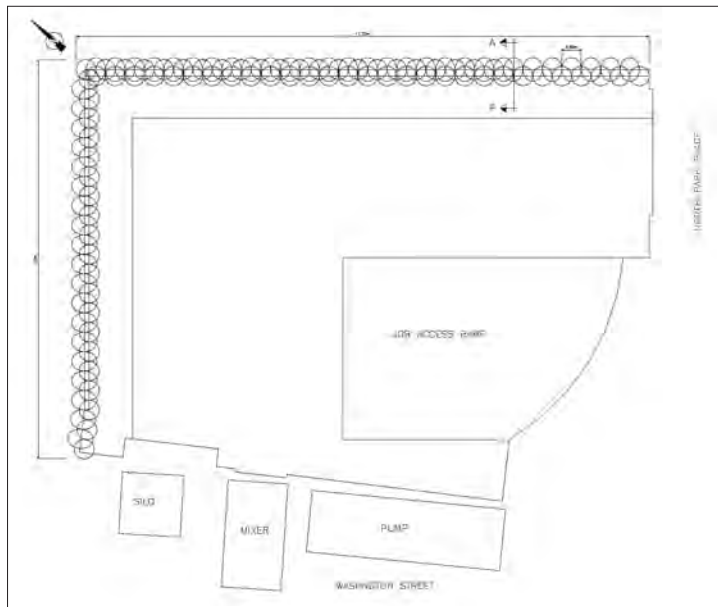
DISPOSICIÓN DE LAS COLUMNAS DE JET-GROUTING.
